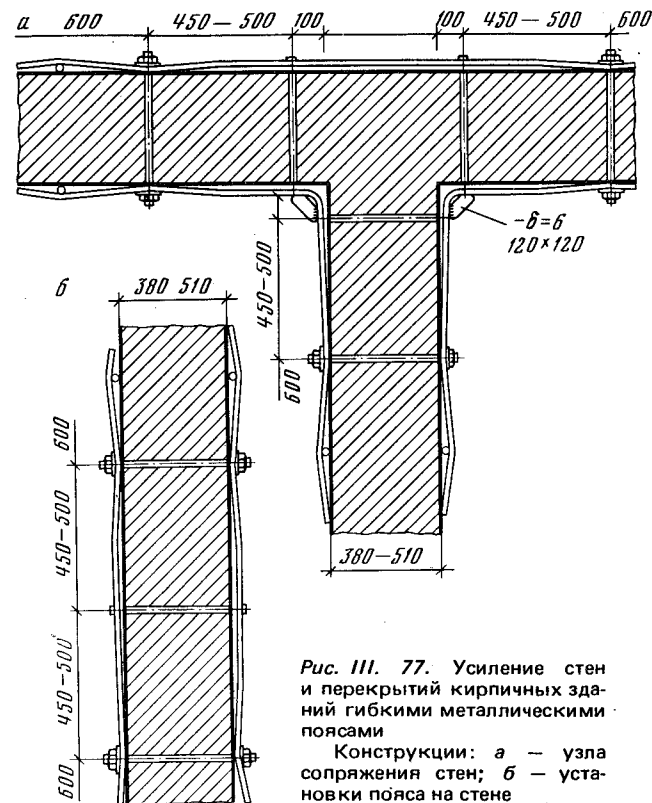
Усиление стен и перекрытий кирпичных зданий гибкими металлическими поясами
